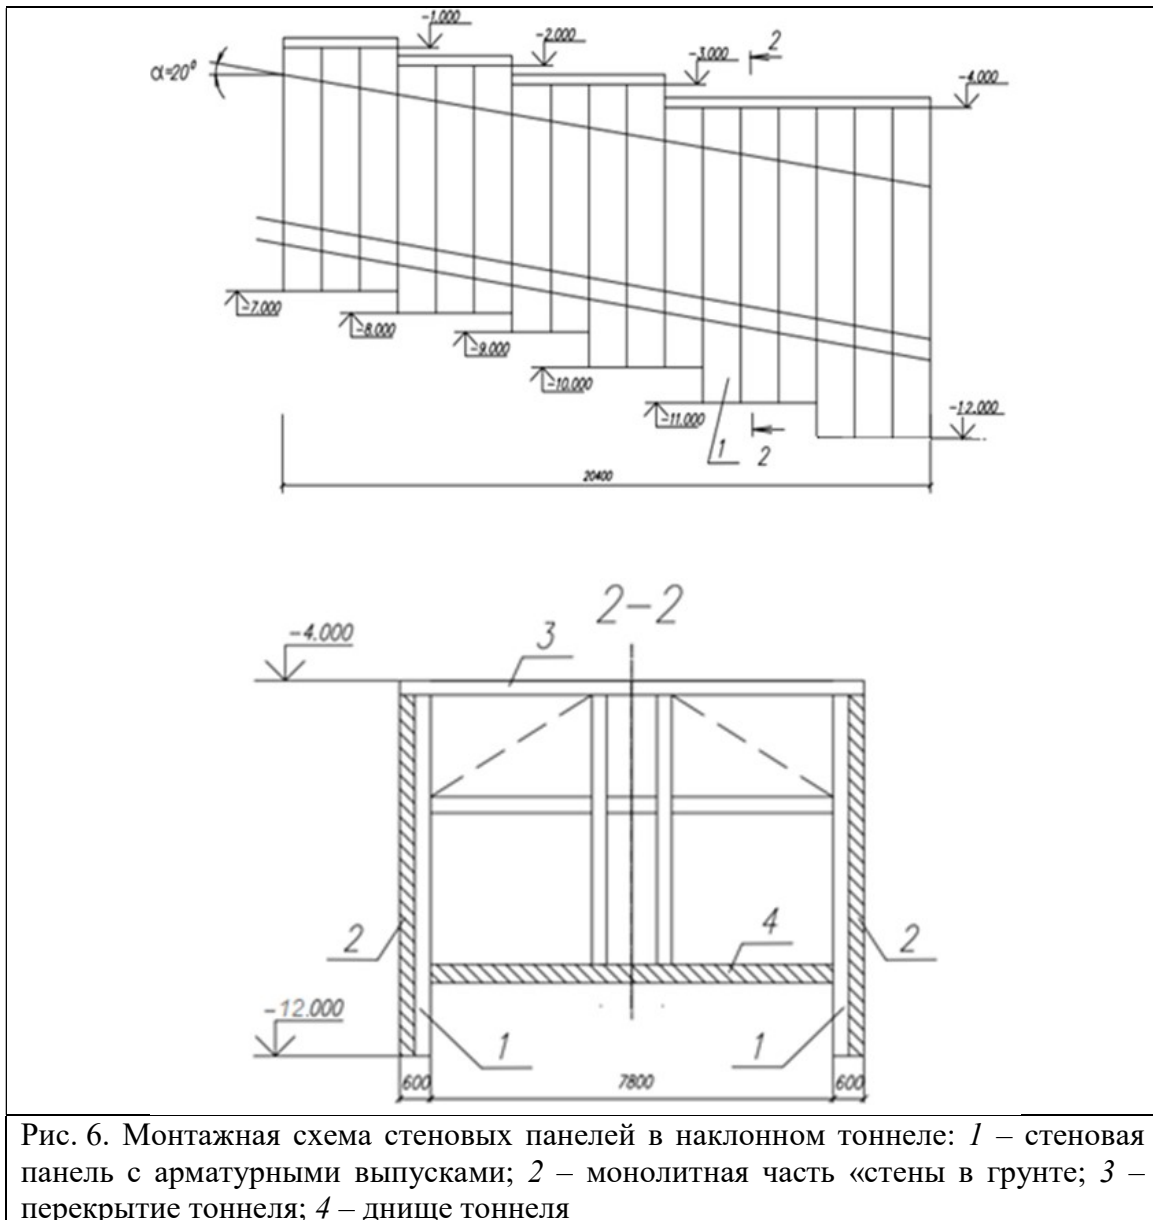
Монтажная схема стеновых панелей в наклонном тоннеле: 1 – стеновая панель с арматурными выпусками; 2 – монолитная часть «стены в грунте»; 3 – перекрытие тоннеля; 4 – днище тоннеля
